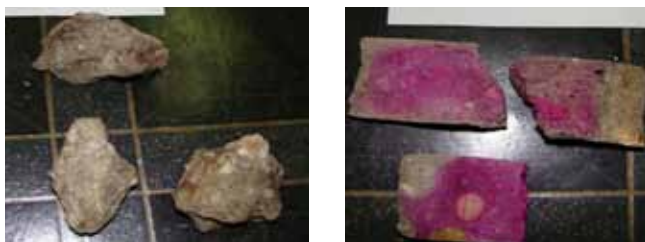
Widok pobranych betonowych próbek kawałkowych
